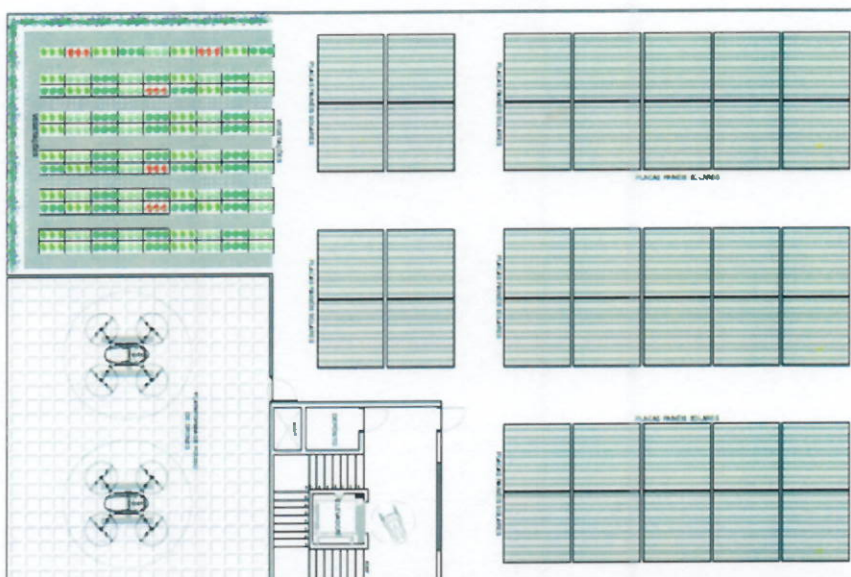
Planta arquitetônica: cobertura (38,00 m²) — caixa d'água, casa de máquinas e área do sistema fotovoltaico.
